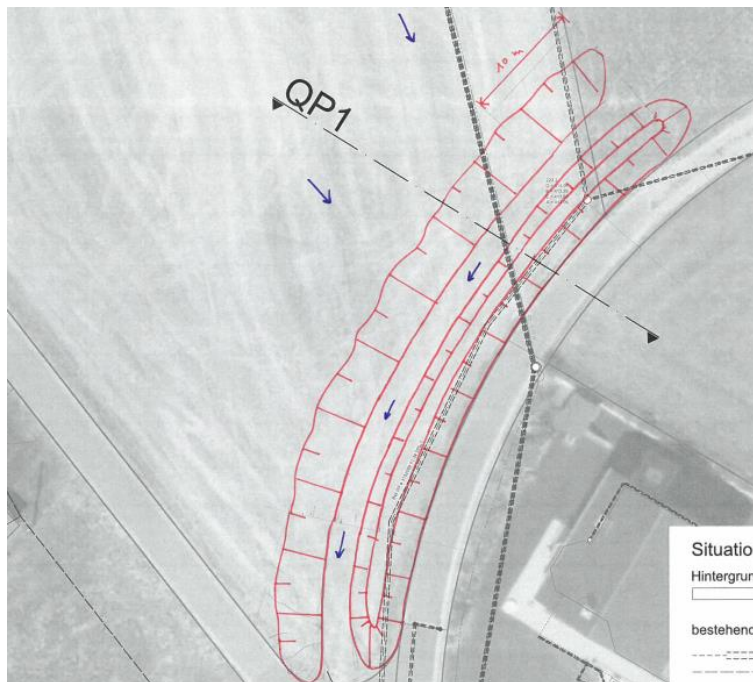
Ausschnitt aus dem Plan zur baulichen Massnahme am Ergetenbach [5].
